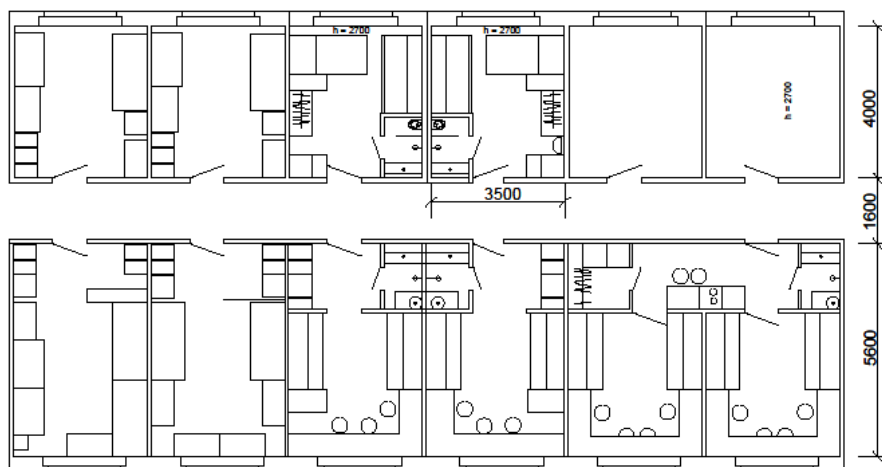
Проектное планировочное решение (предлагаемое) плана типового этажа
